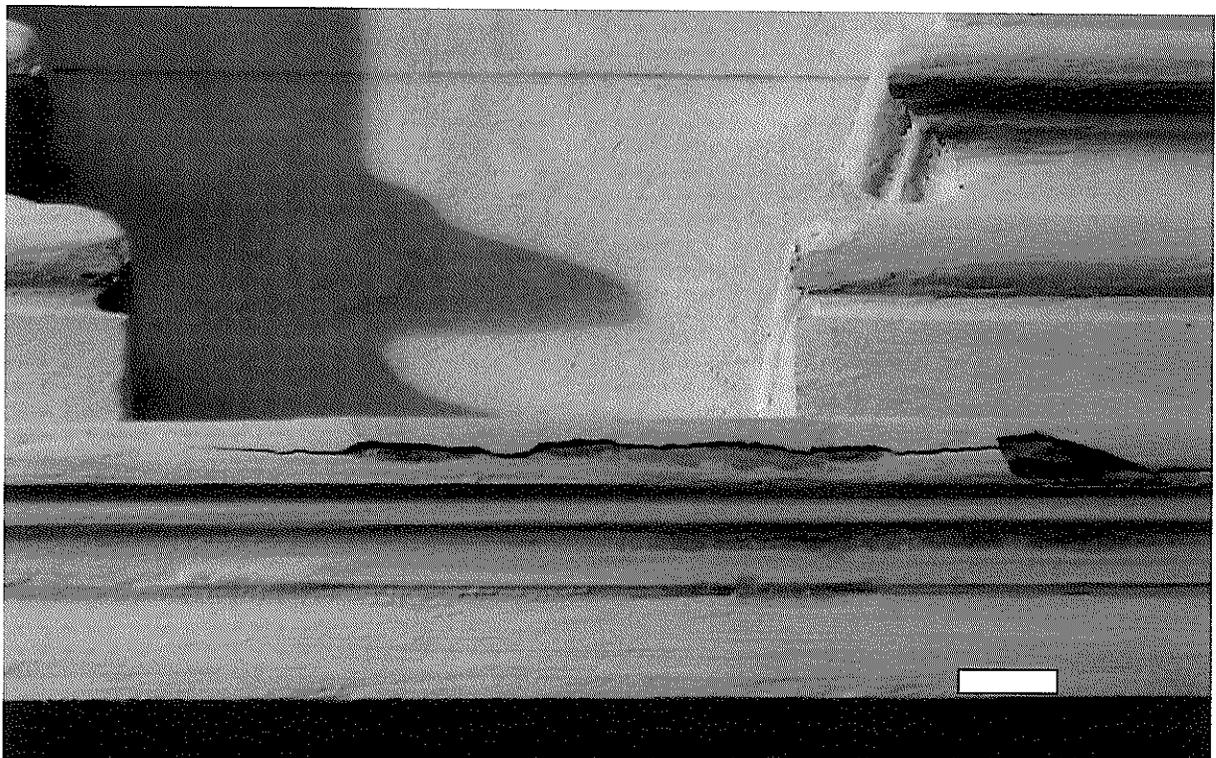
Fisura en saliente con desprendimiento de estuco.
